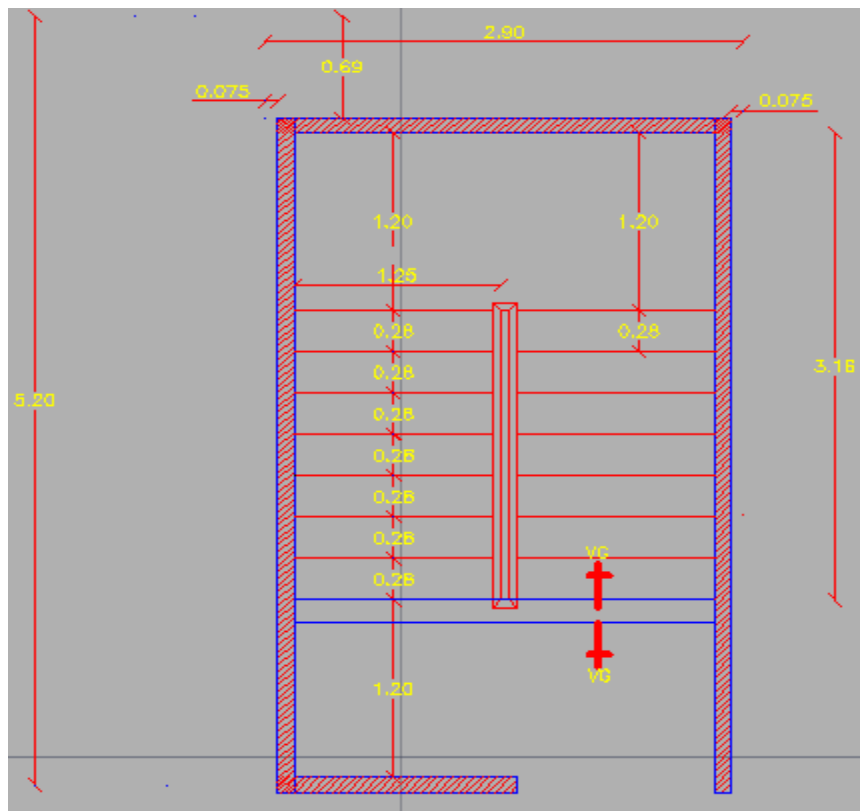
Peldaños y ancho de escaleras principales. Fuente: Constructora Adriana Rivera.
